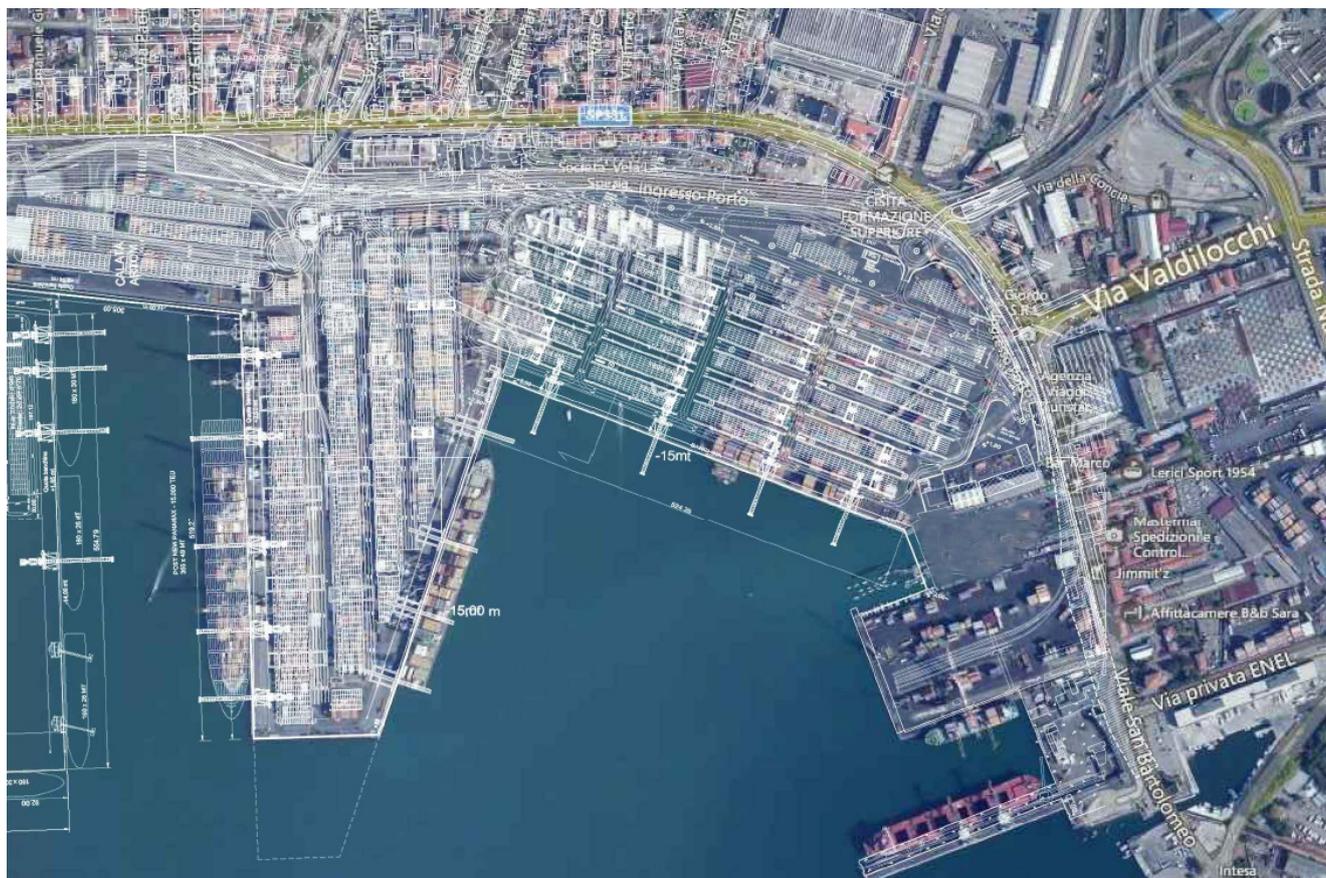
Marina del Canaletto: planimetria di progetto su fotopiano
